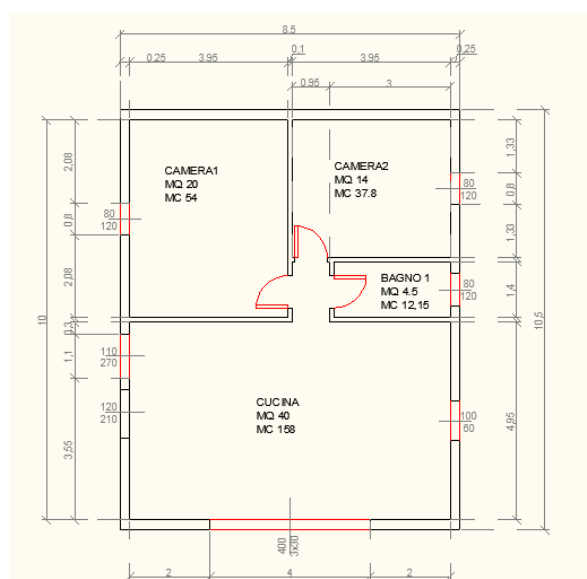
Planimetria del piano terra dell'edificio prefabbricato in legno.
